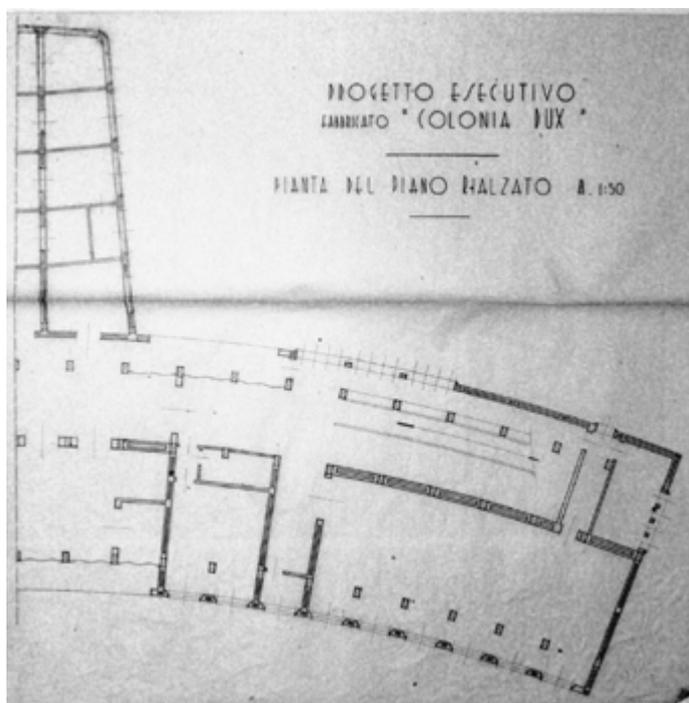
Dettaglio della pianta del piano terra in scala 1:50, primo progetto (© Paolo Sanjust)
